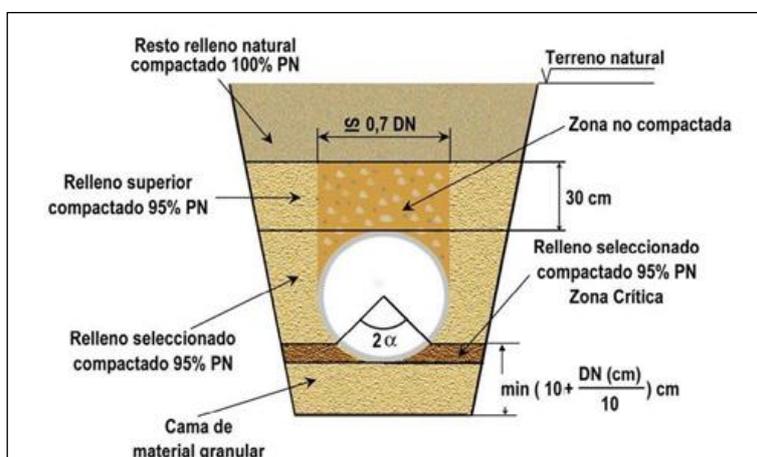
Detalle de la zanja de las tuberías de conducción de la instalación de riego.
